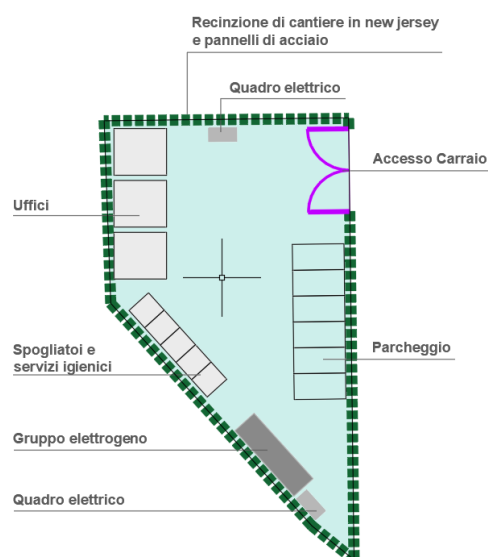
Area di cantiere Ex Ilva demolizione diga - P3062\_E-SC-A-0105
